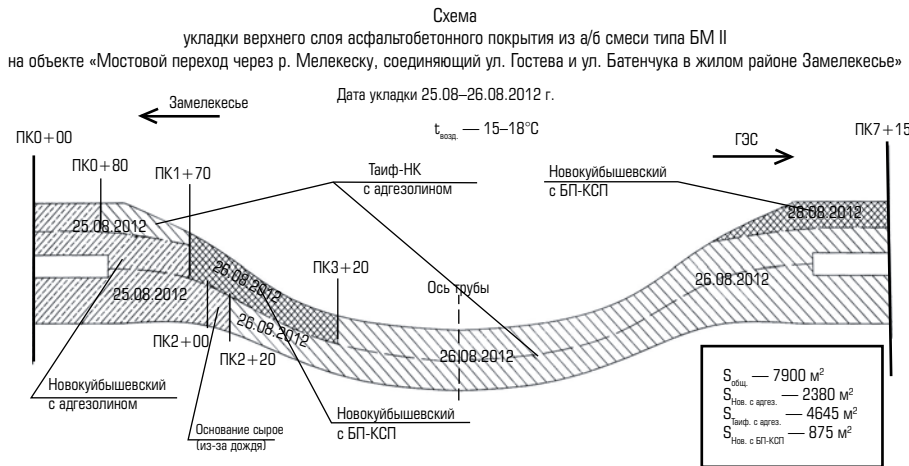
Схема укладки верхнего слоя асфальтобетонного покрытия с участием комплексной адгезионной присадки «Адгезолин»
